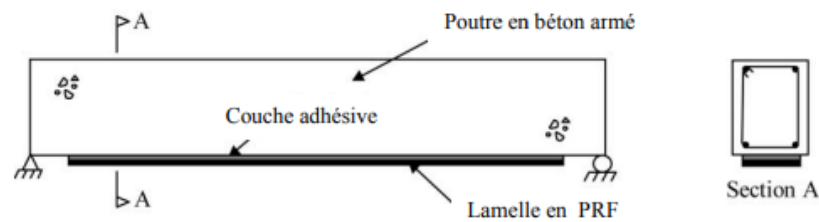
Une poutre en béton armé renforcée par une lamelle en PRF (Smith et Teng 2002
